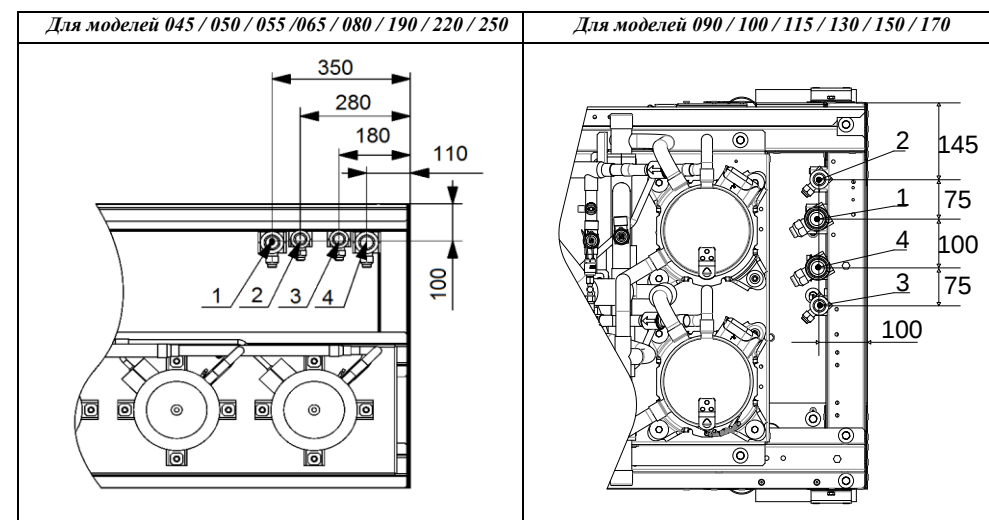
Расположение присоединительных патрубков фреонового контура (вид сверху).
